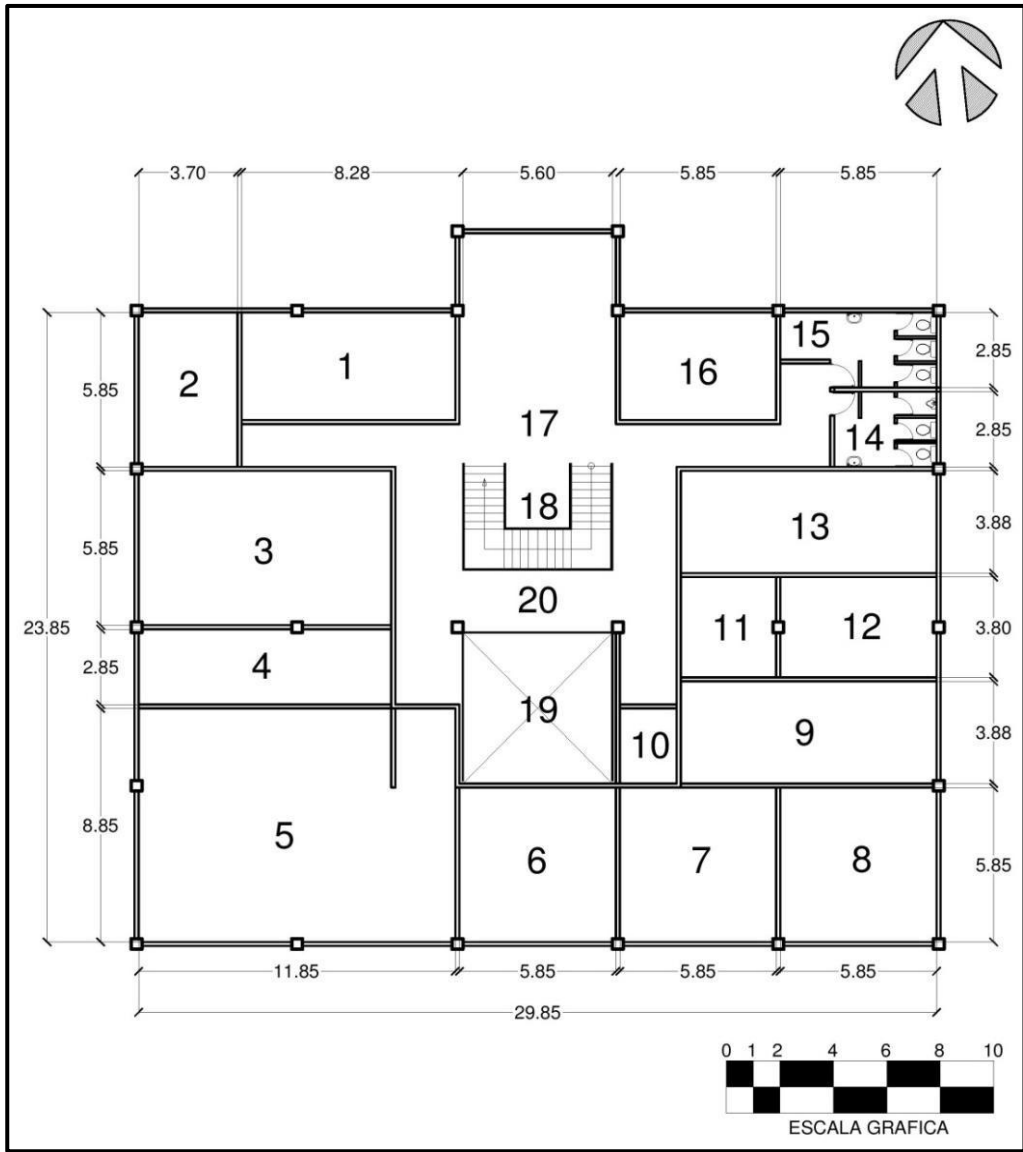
PLANTA ARQUITECTÓNICA 2do NIVEL EDIFICIO DE QUÍMICA
